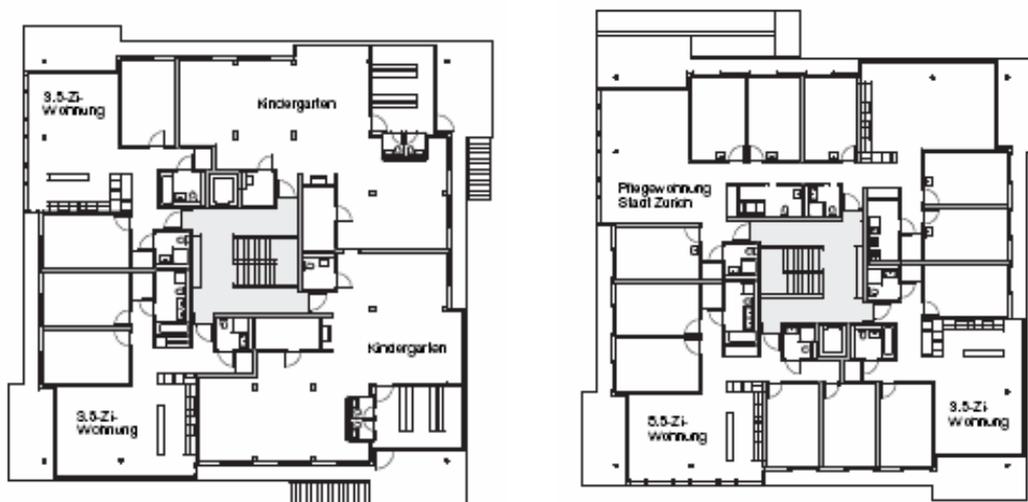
Siedlung Steinacker in Zürich, Grundrisse (Zeichnung HS&P)
